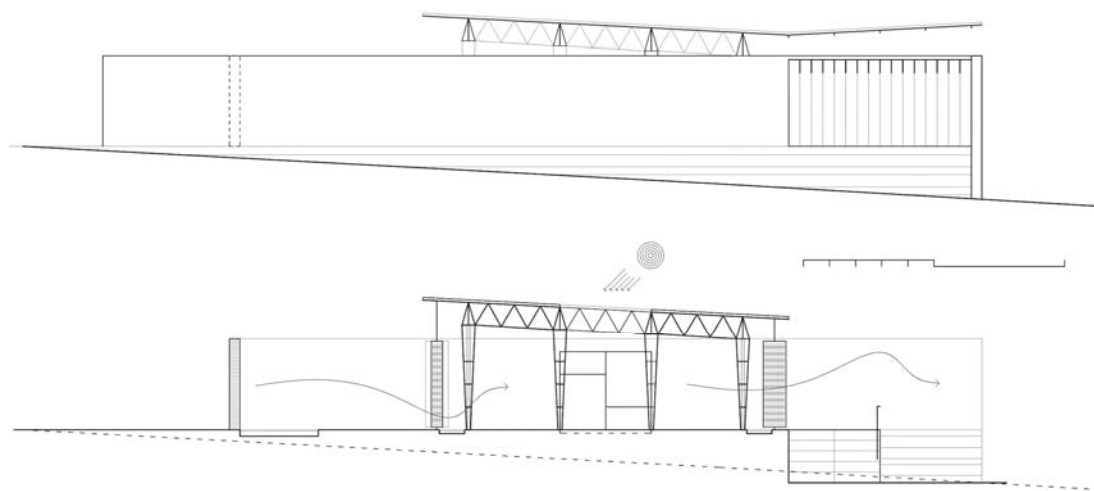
Alzado noreste y sección transversal por la sala con “impluvium” y lamas de cañizo orientables . Dibujo del autor.
